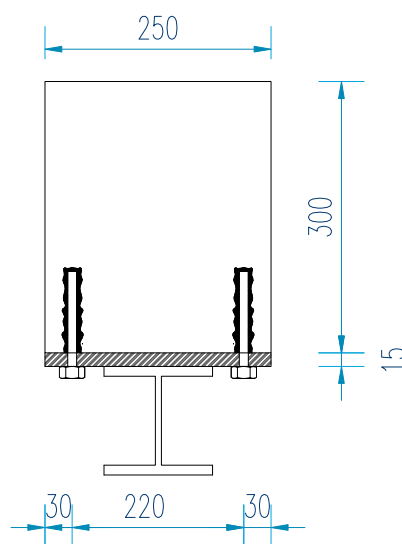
Ligação metálica do perfil em vigas de betão armado
